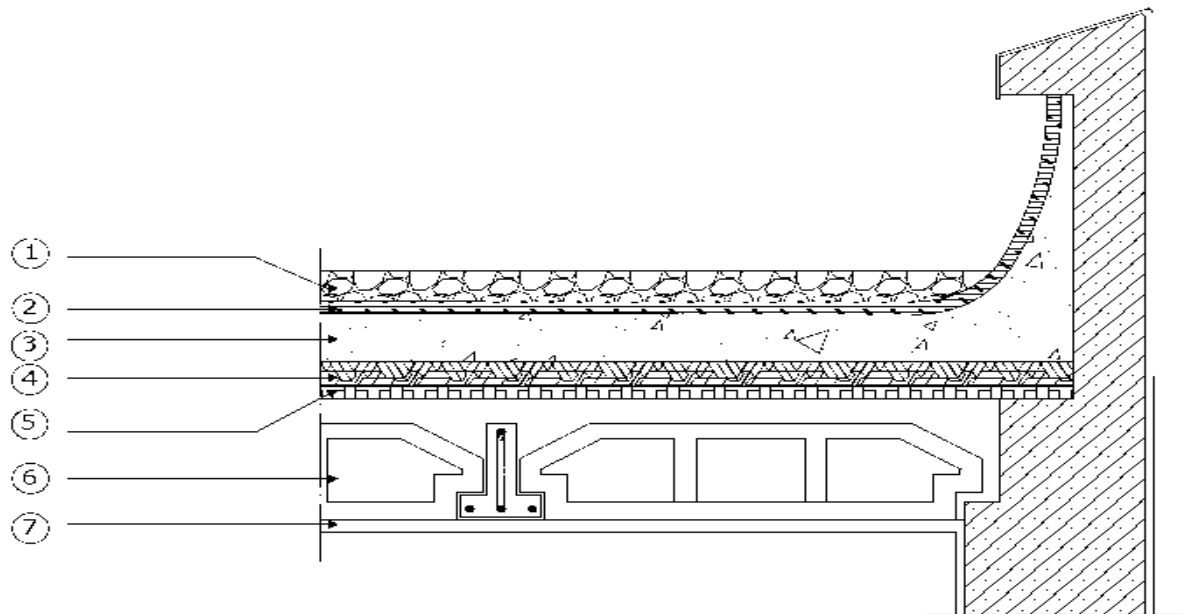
Schéma descriptif du plancher terrasse inaccessible.
